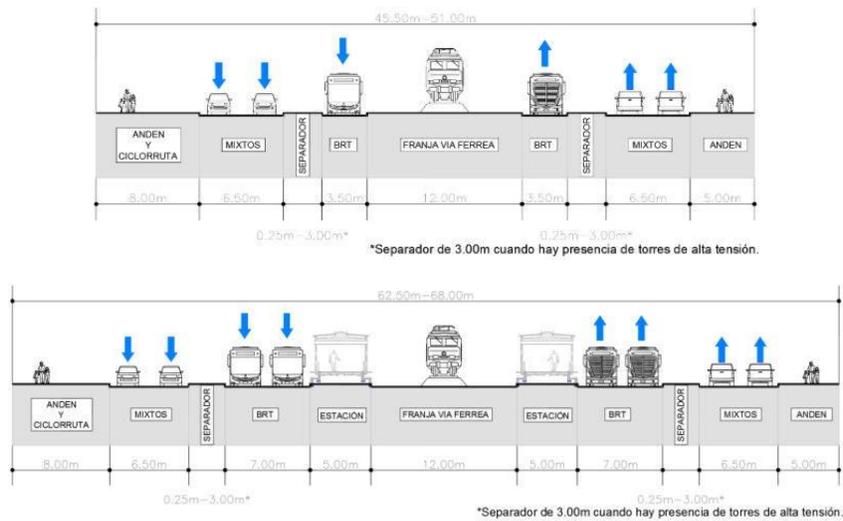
Sección transversal típica– Alternativa 1 (Franja Férrea 24m)
